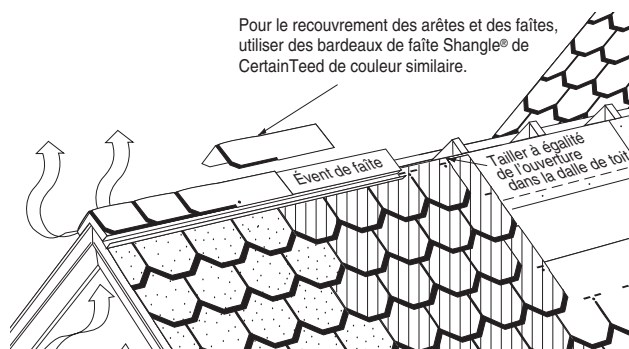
Pose de bardeaux Shangle Ridge sur un événement de faîte.
